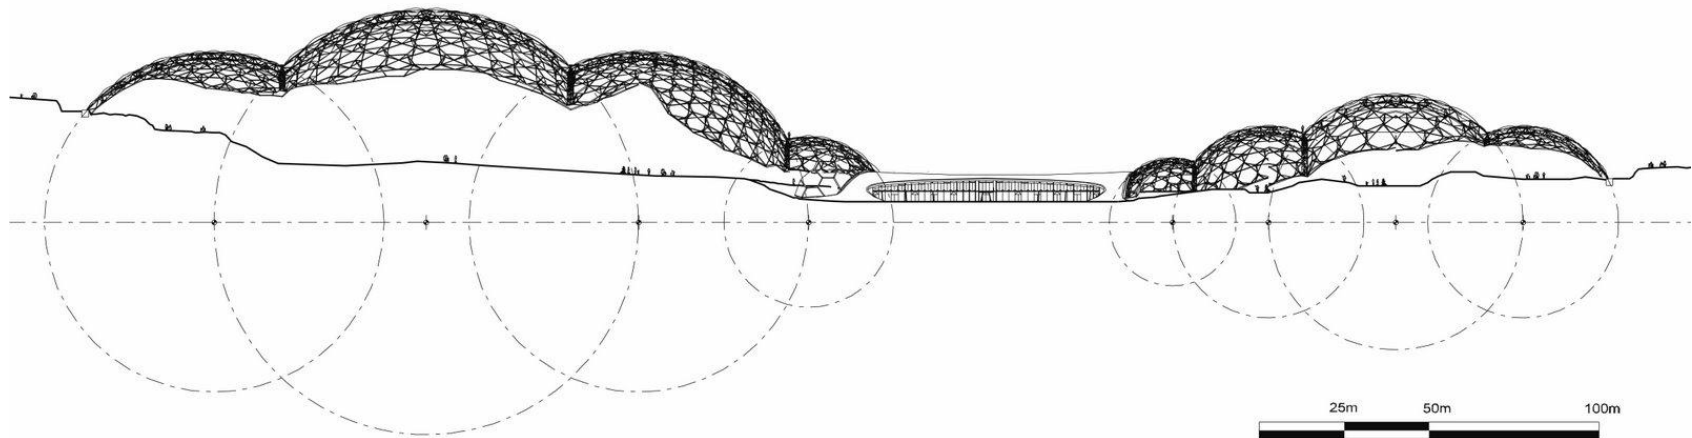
DESARROLLO DE LA ESTRUCTURA.
